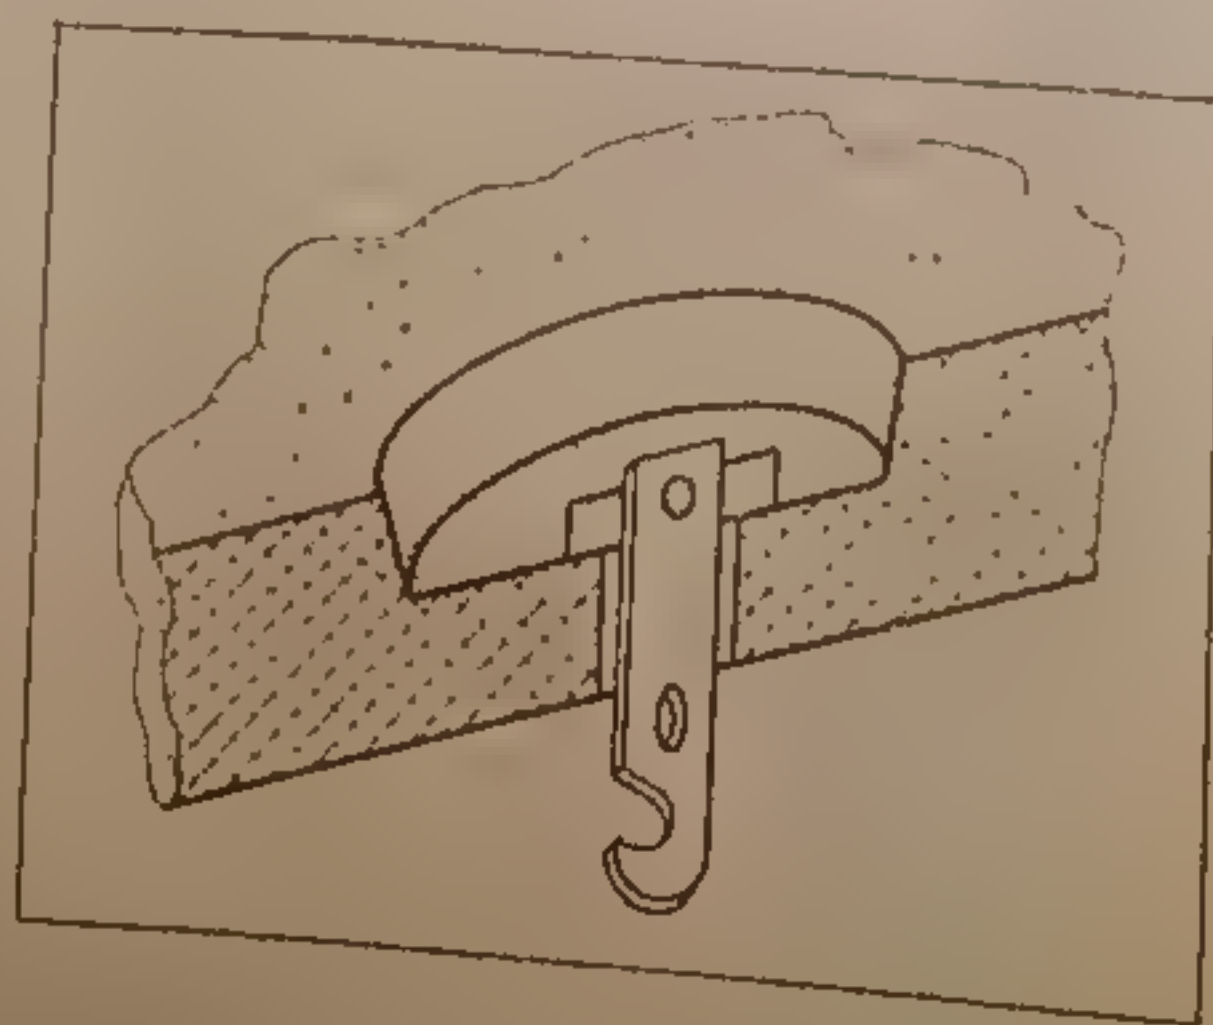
Крюк для подвески к плите перекрытия светильников массой до 5 кг
